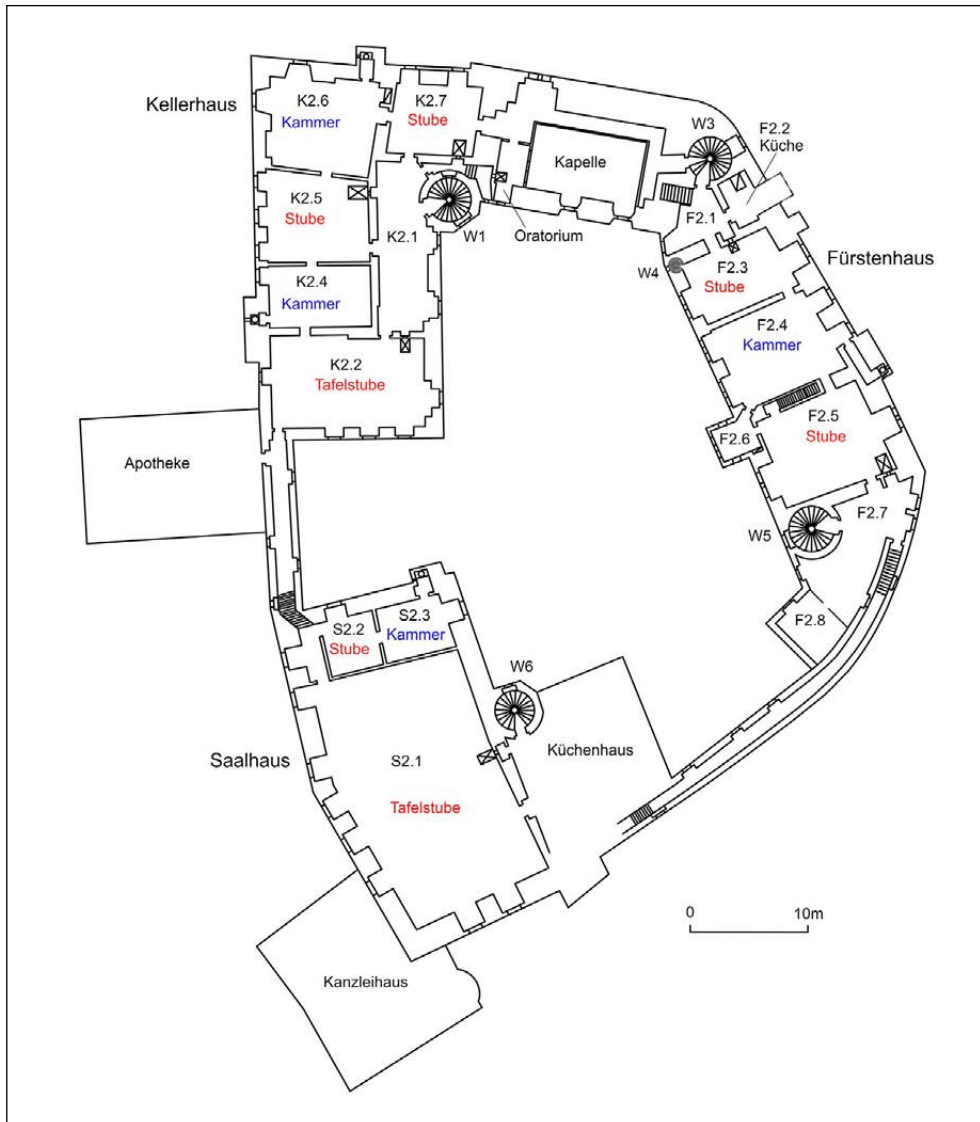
Colditz, Schloss Colditz, zweites Obergeschoss, Grundriss, Rekonstruktion der Raumfunktionen 1603–1622
